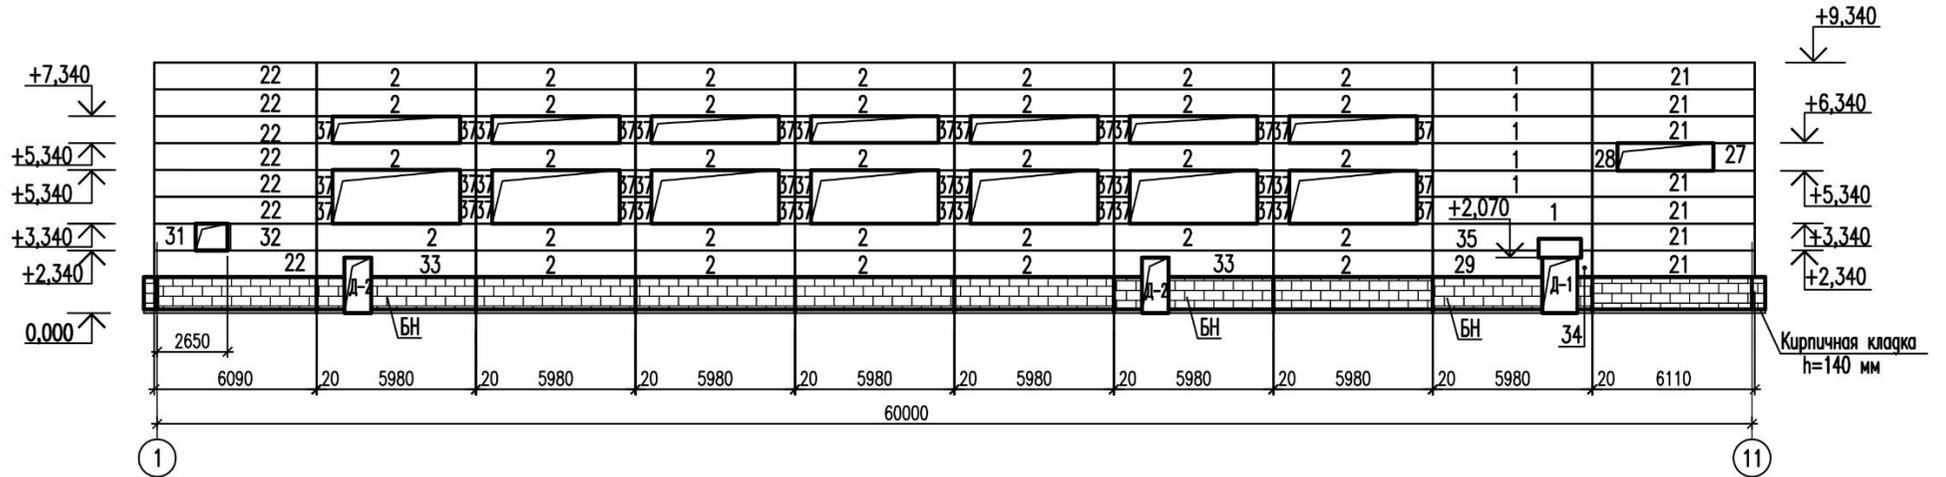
«Схема раскладки сэндвич-панелей на фасаде 1-11» [40]
